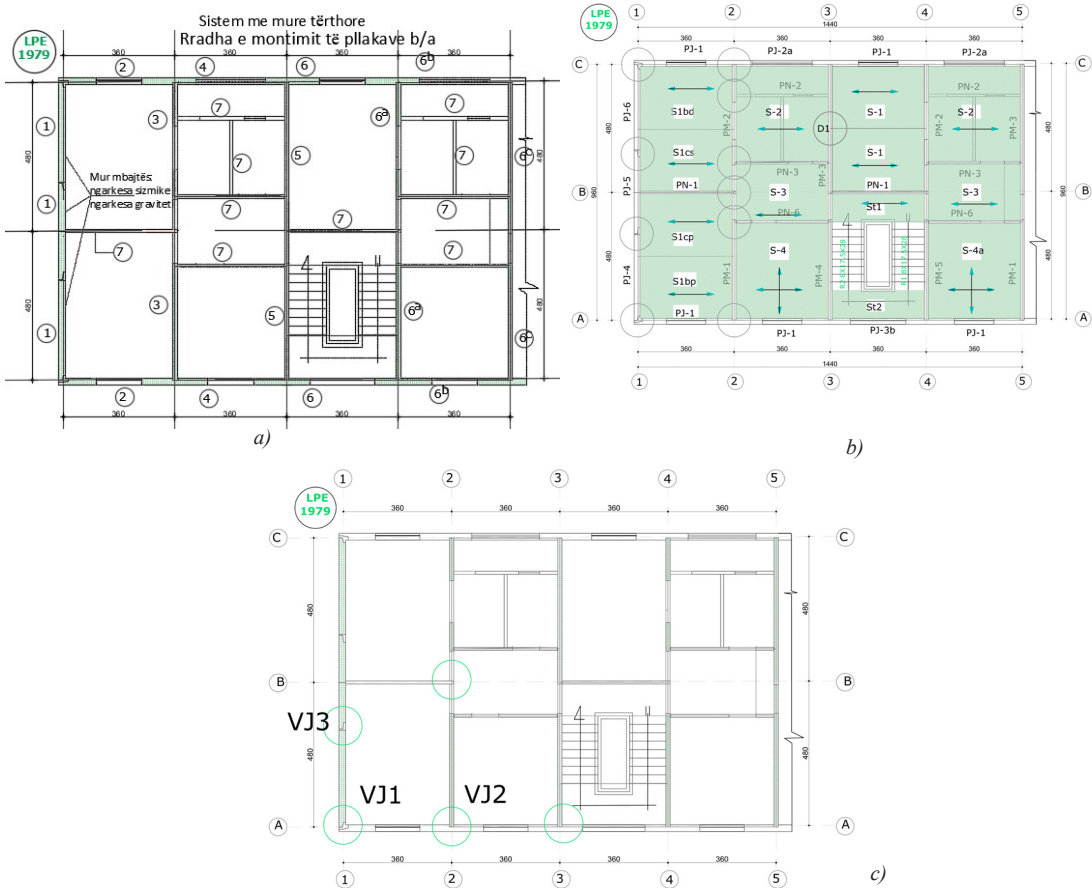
Ndërtesat me pllaka beton arme të parafabrikuara në Shqipëri: a) një planimetri që tregon skemën e montimit të paneleve të murit; b) plan strukturash të katit tip, dhe c) planimetria tip që tregon vendndodhjet e nyjeve vertikale VJ1, VJ2 dhe VJ3.
